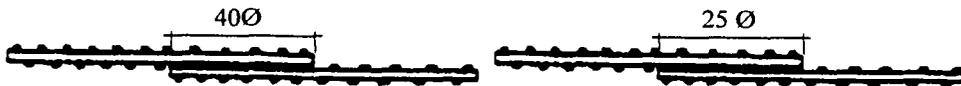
Empalme traslapado con un traslape mínimo de 40Ø a tensión y 25Ø a compresión.
